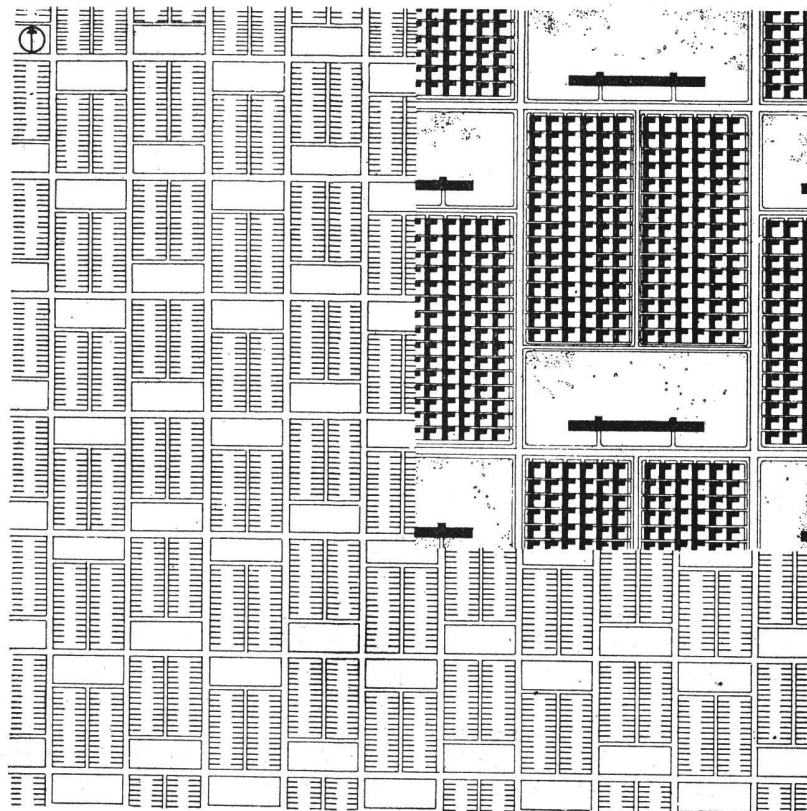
Construcción mixta. Casas libremente situadas en forma de L (casas de piso bajo) y casas-glorietas de enrejado. Acceso a los bloques mediante pasajes. 1:7000, 1:20.000. Compárense figuras 1, 5 y 11.
